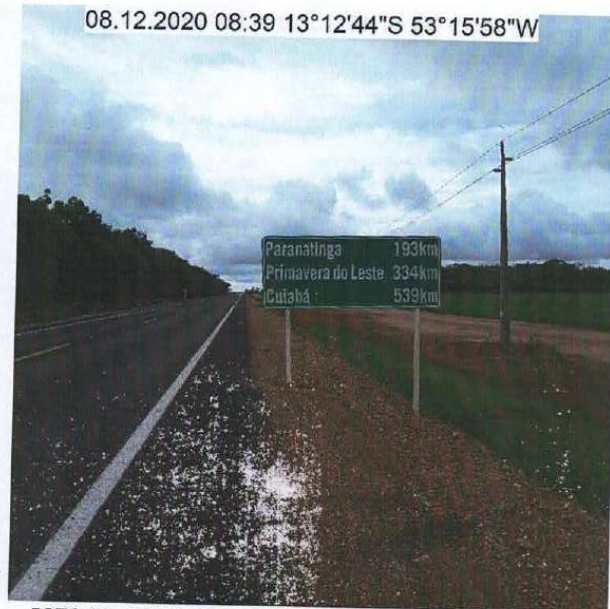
DETALHE DE PLACA DE INDICAÇÃO IMPLANTADA
